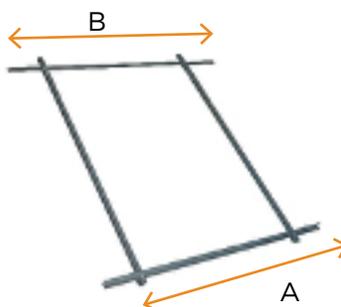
Montaje sobre cubierta plana (8) captadores plano
